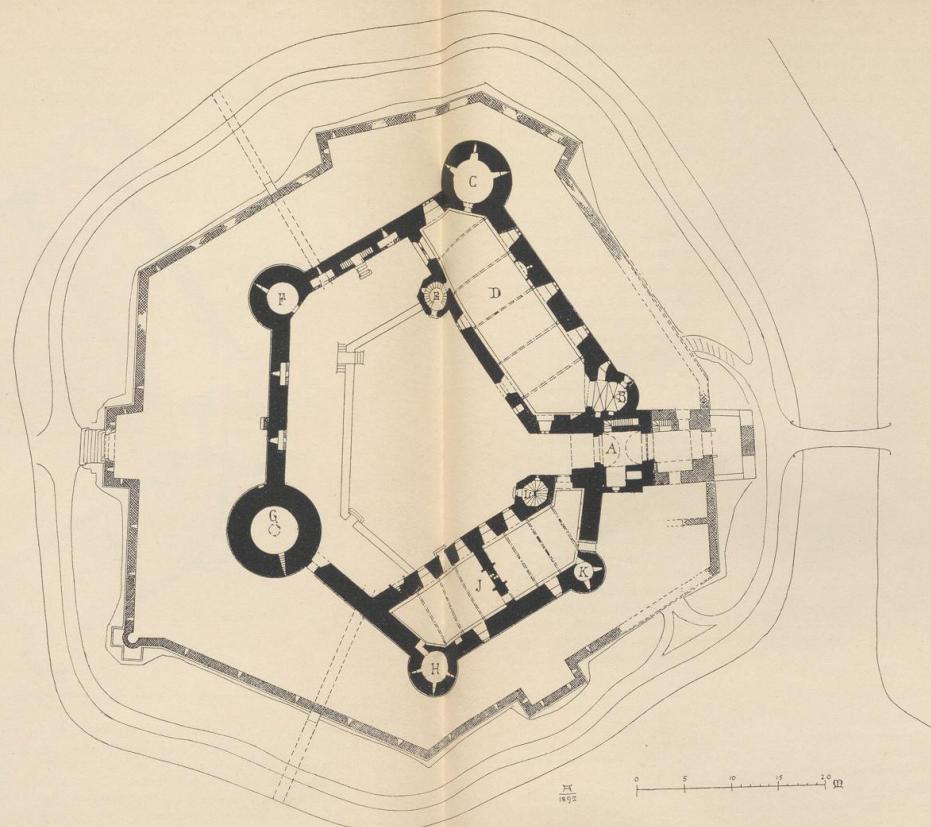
Schloss Linn. Grundriss des Hochschlosses (Schnitt durch das obere Stockwerk).
